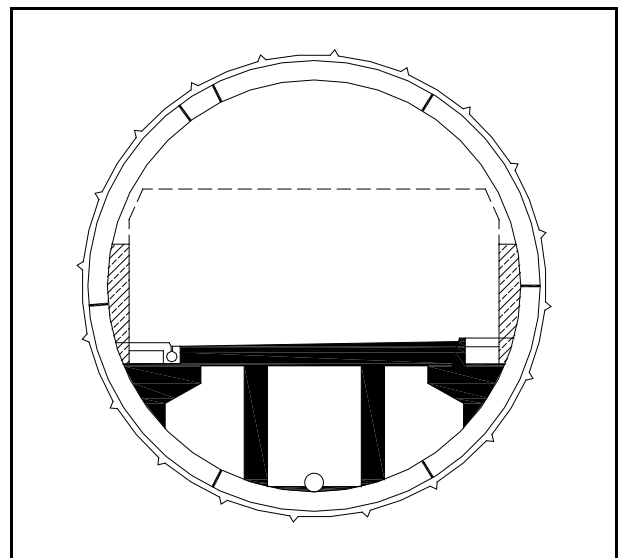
1-schalige Konstruktion mit aufgeständeter Fahrbahn
